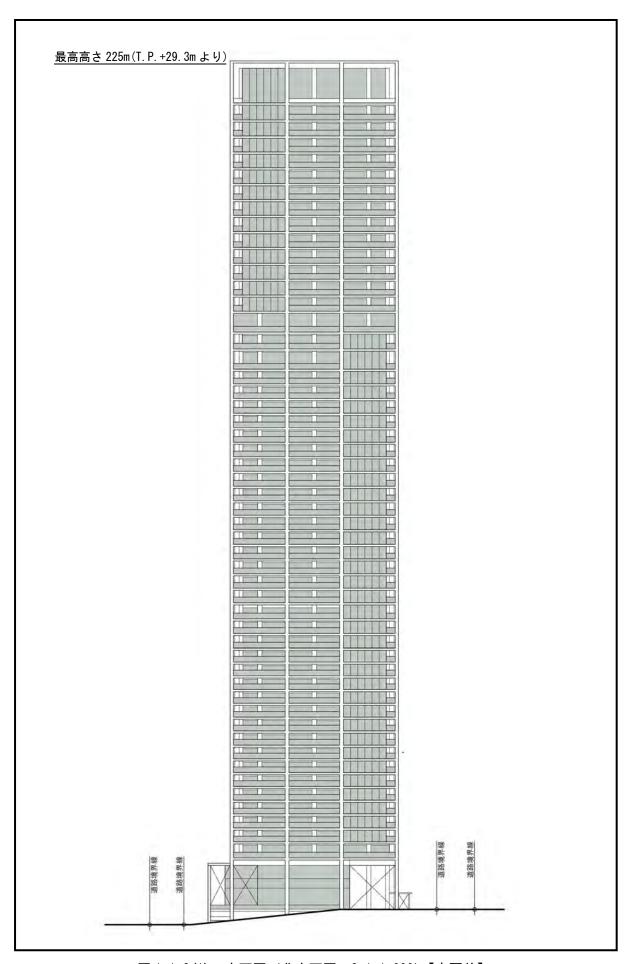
(1) 立面図 (北立面図 S=1:1,000)【変更前】
